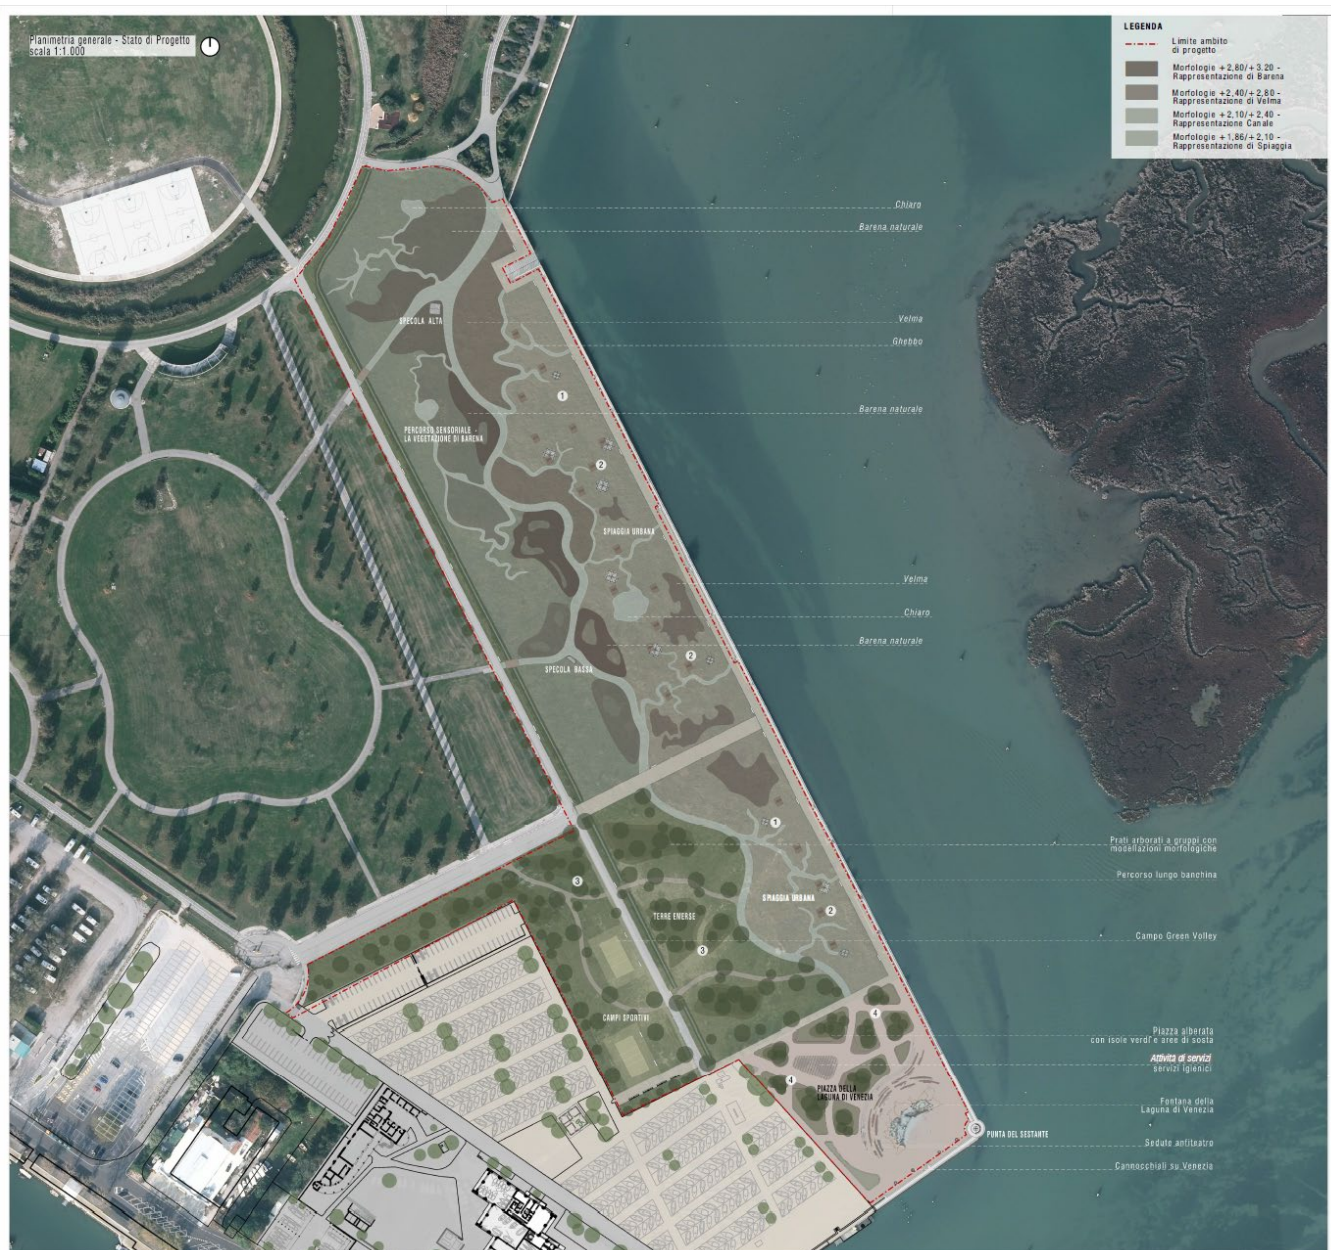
Planimetria generale prima fase con i soli interventi a terra
